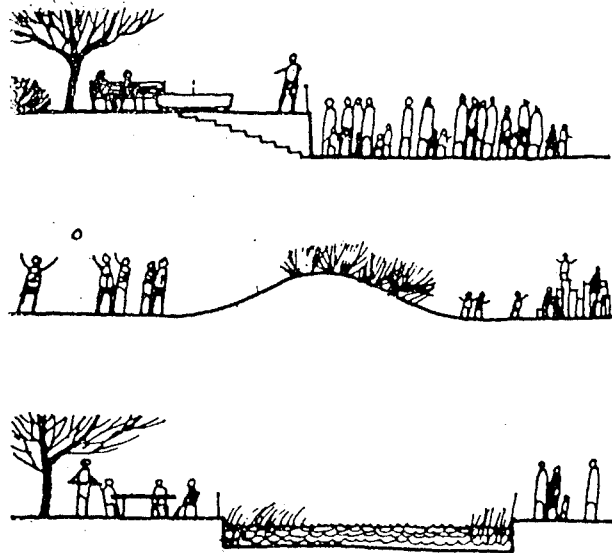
Alternatif Perencanaan Ruang Luar.
